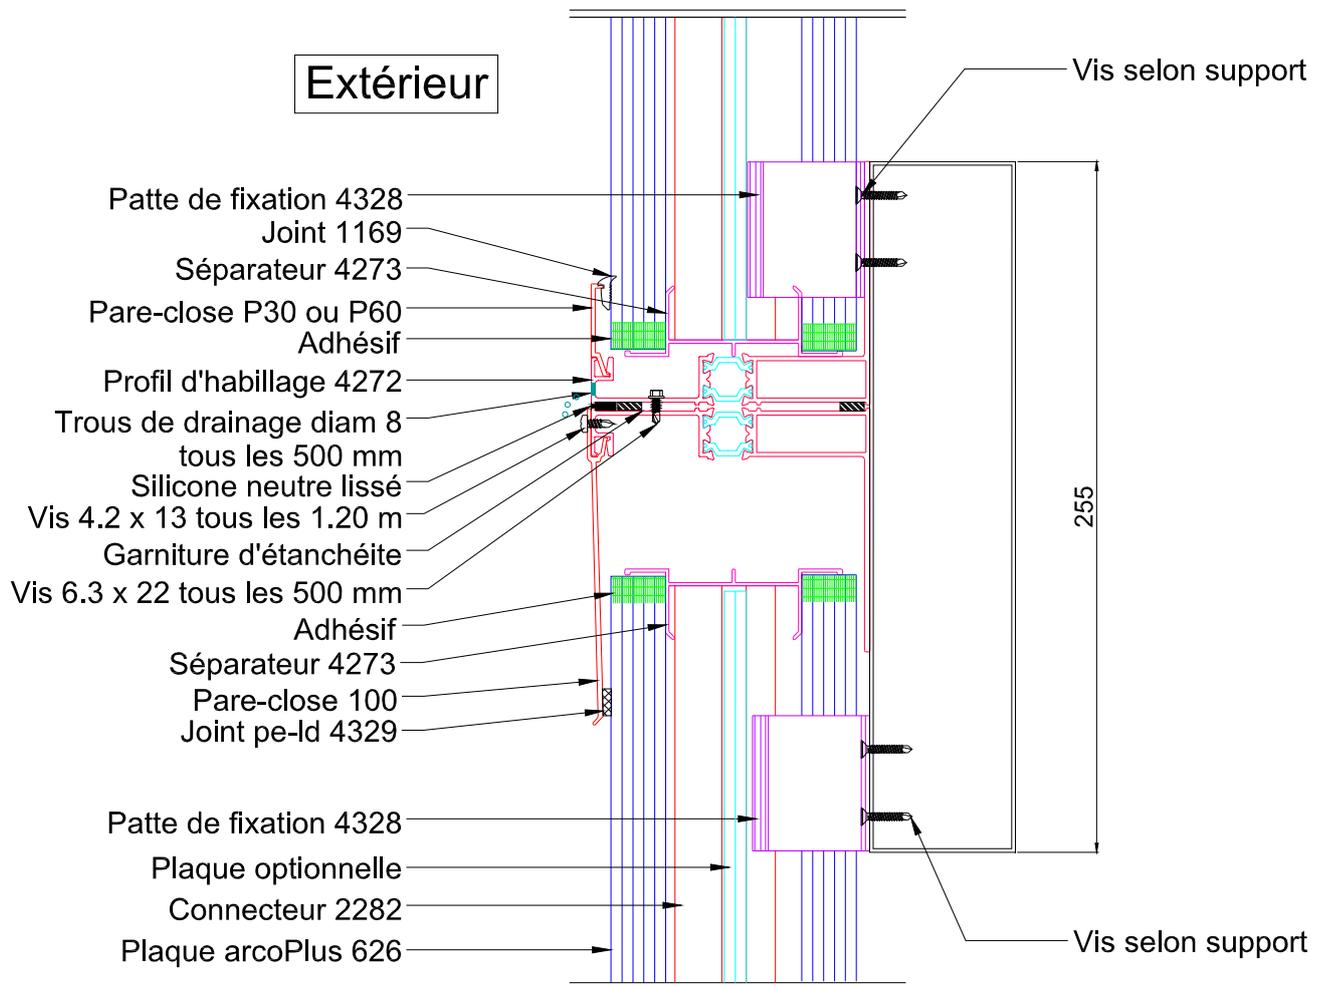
Raccord de hauteur n°2 : façade basse limitée à 10 mètres de haut -
